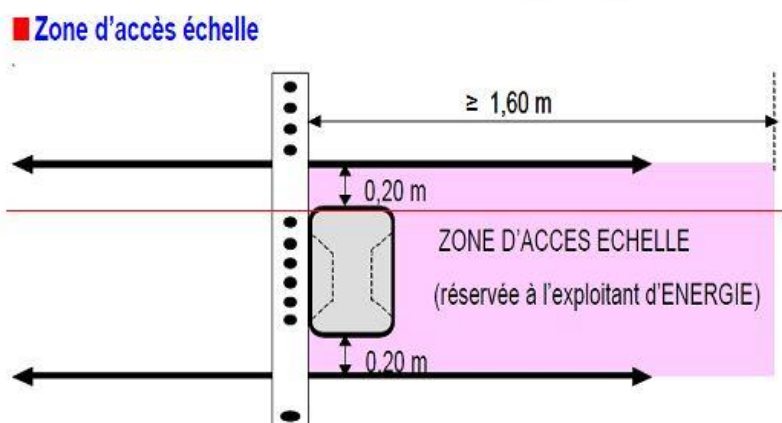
Zone d'accès échelle sur Réseau BT et mixte
